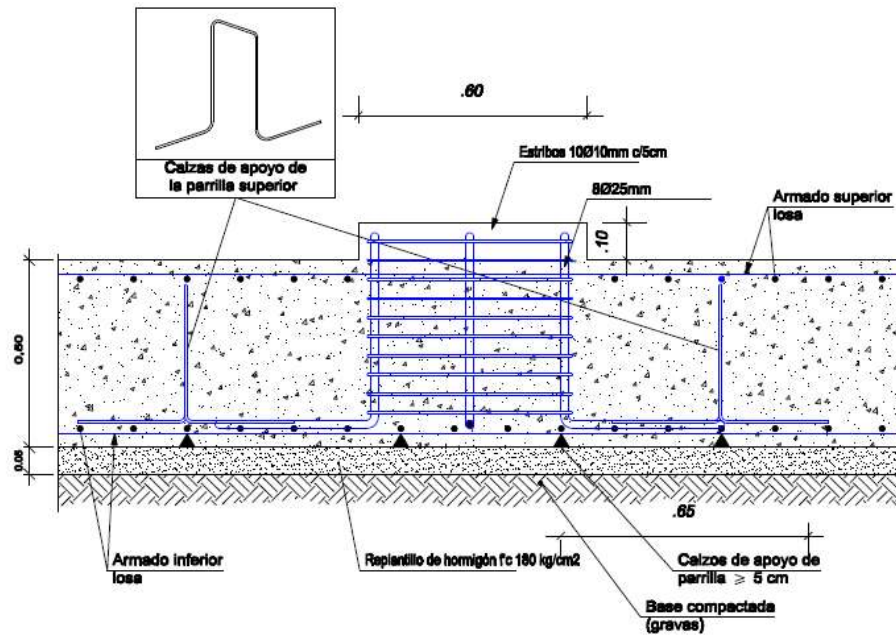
Detalle de refuerzo de las bases de los aisladores.
